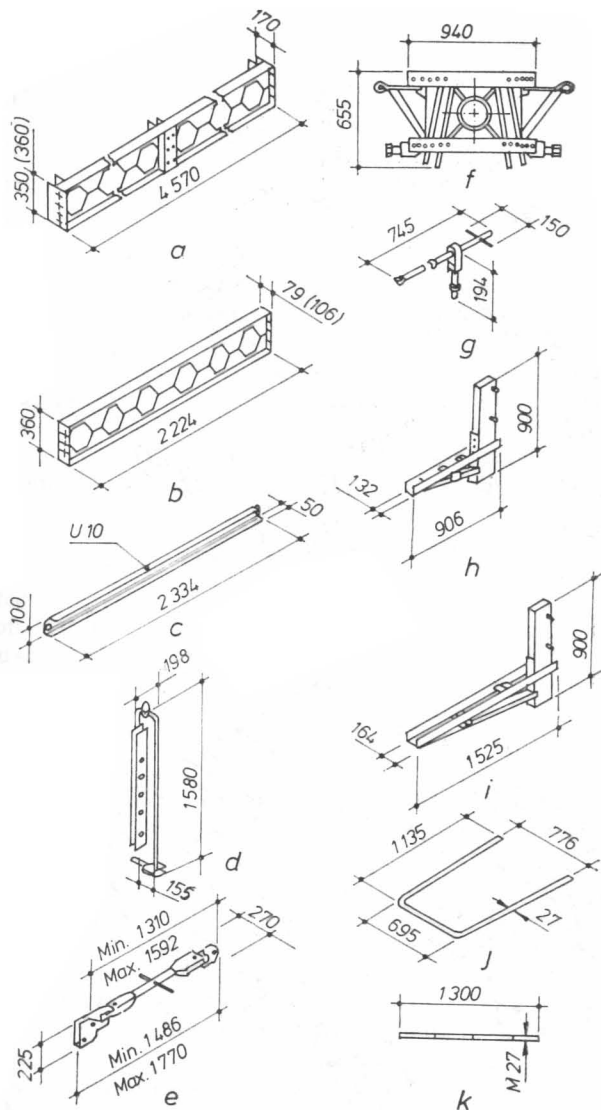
Elementele componente ale platformei suspendate pentru cofrat planșee de 6,00 x 6,00 m:
